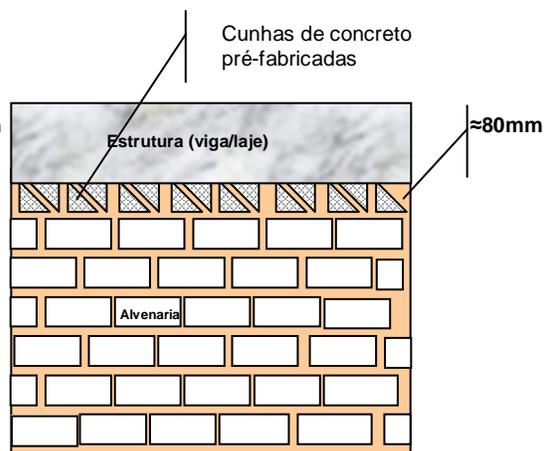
Esquema do travamento com cunhas pré-fabricadas (NBR 8545:1984).
